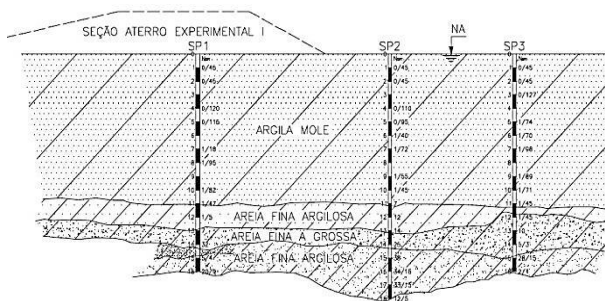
Perfil da área em estudo às margens do Rio Sarapuí (adaptado de Ortigão, 1980).
